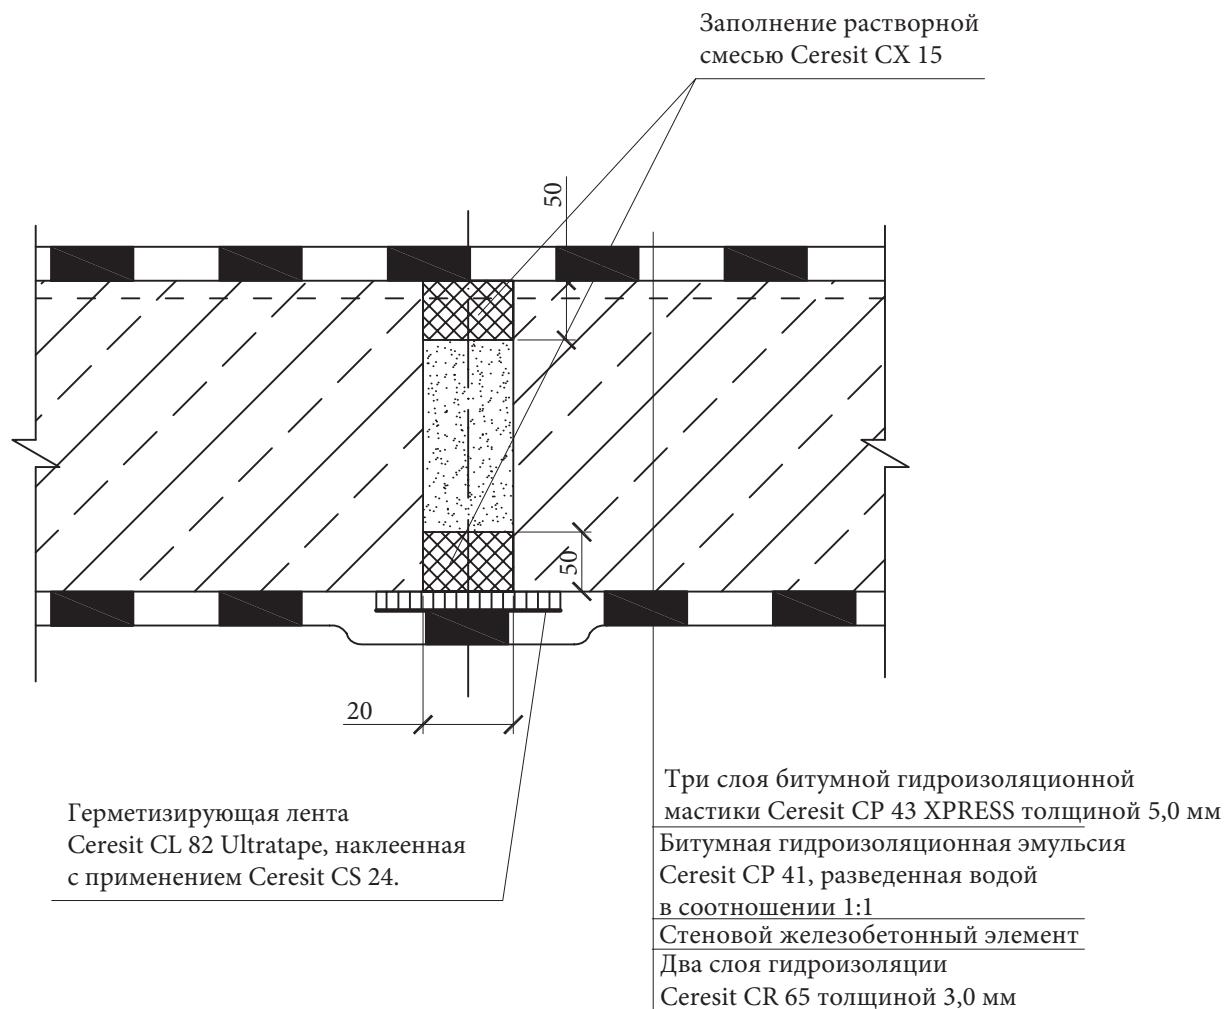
Конструкция герметизации стыков между сборными стеновыми элементами железобетонных резервуаров для питьевой воды без облицовки
